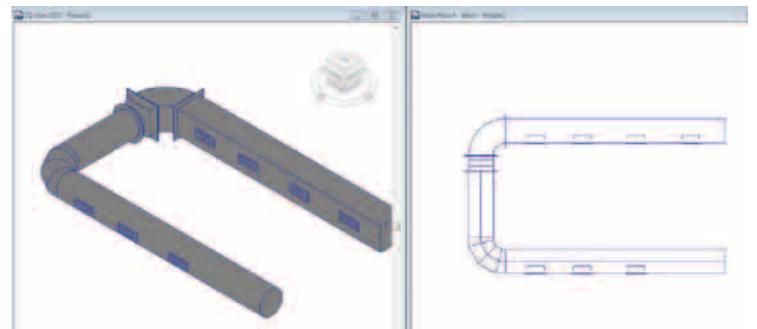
Размещение вентиляционных решеток на воздуховодах.
